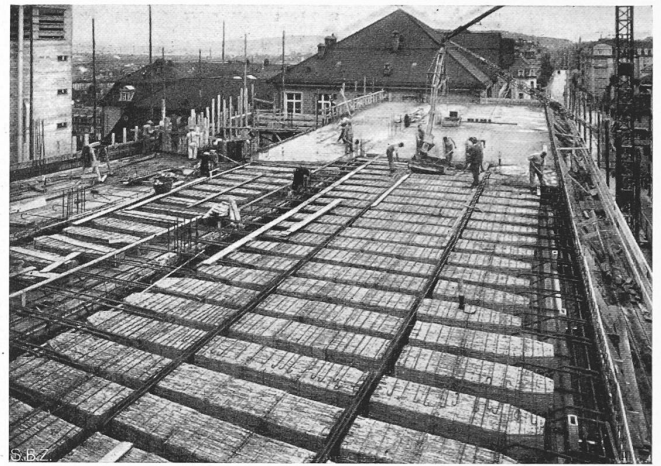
Betonieren der Rohrzelldecken im Lehrgebäude (26. 4. 33).
